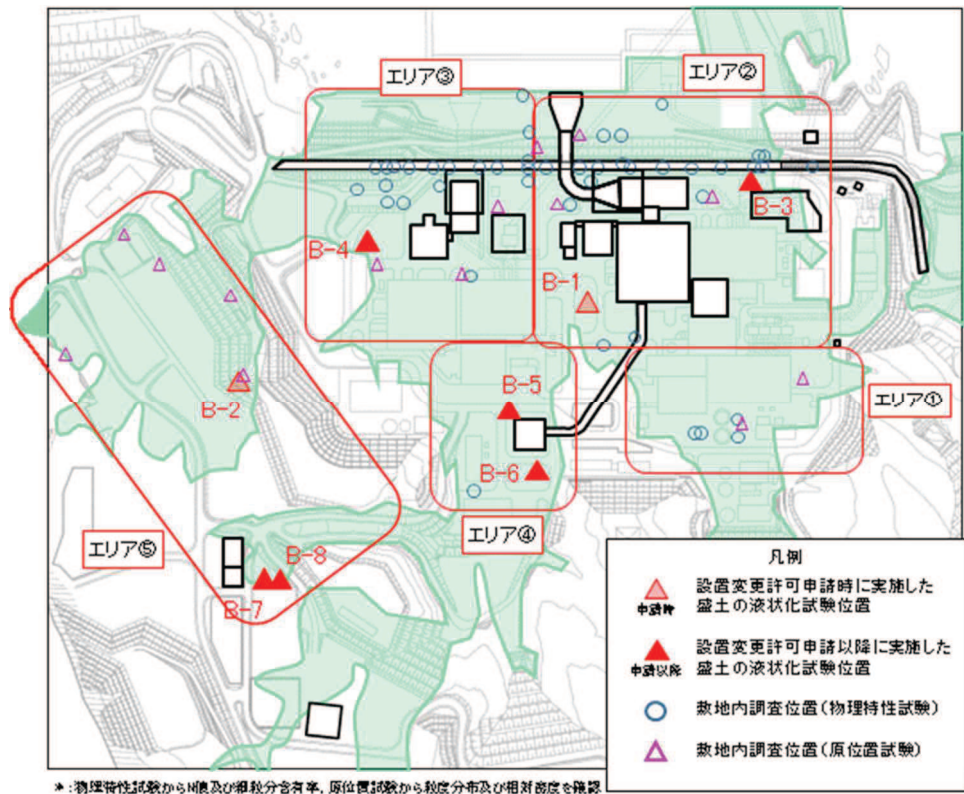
盛土の液状化強度試験位置及び敷地内調査位置の平面図
